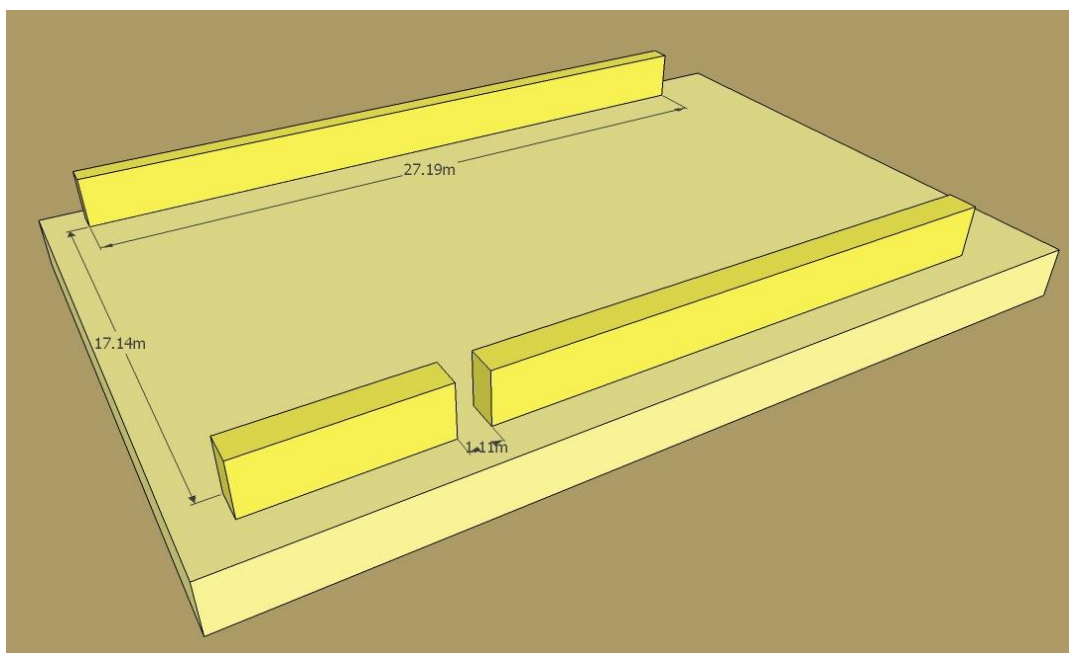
Fase constructiva 1: isometría
